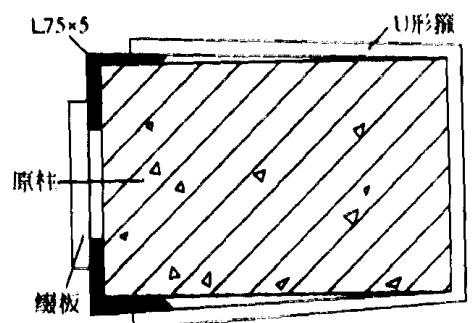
预应力钢支撑杆加固某钢筋混凝土柱
